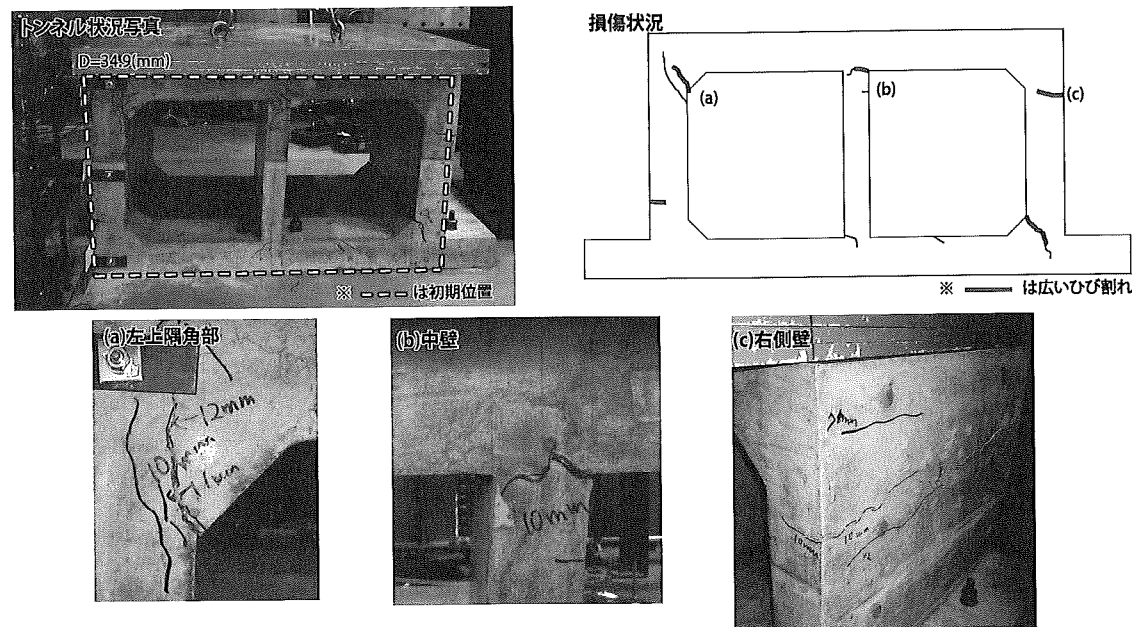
変位34.9(mm) [変形角：約37/1,000] 時点の損傷状況
